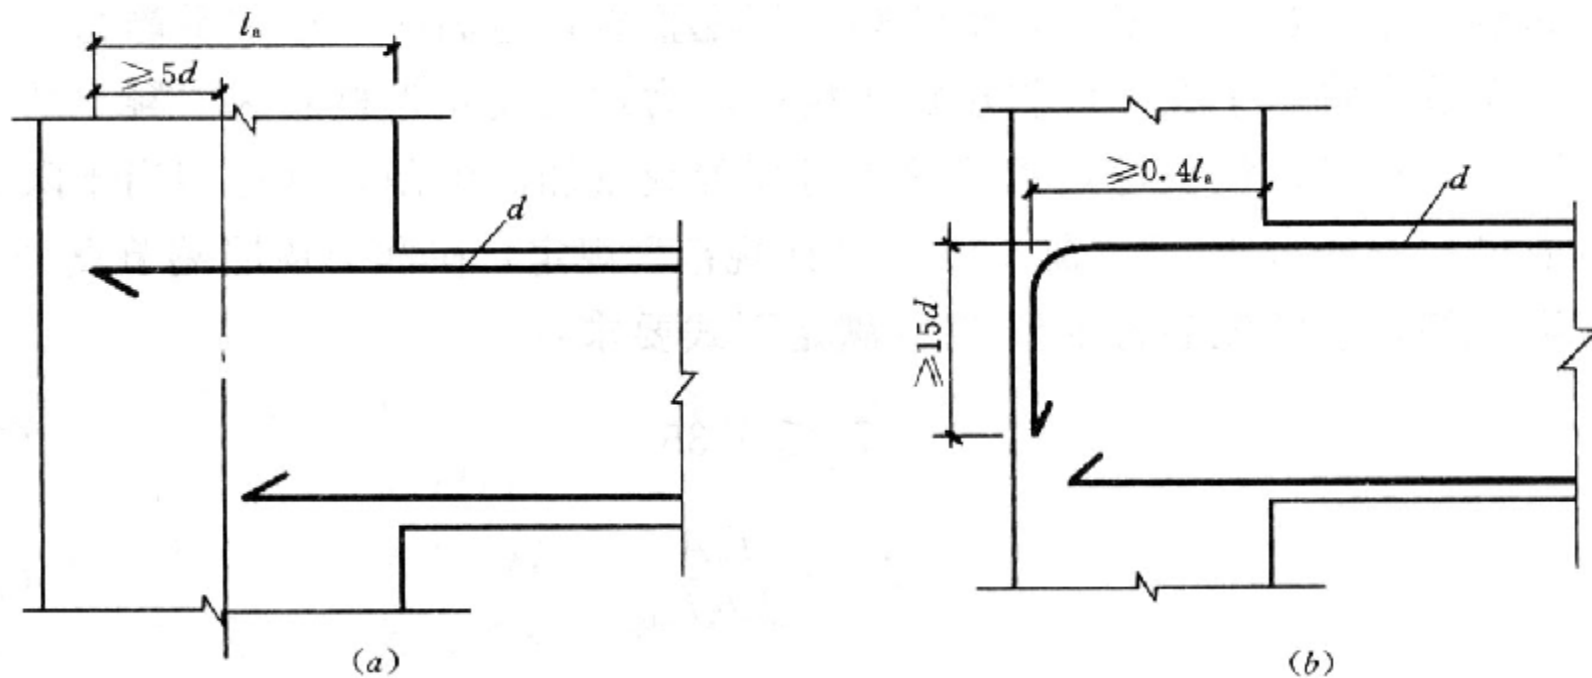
框架中间层端节点梁纵向钢筋的锚固
